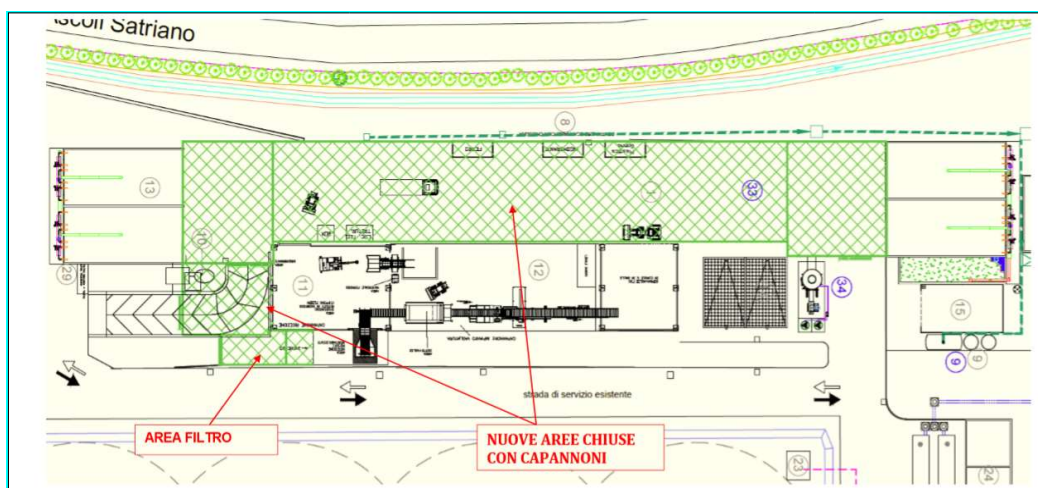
stralcio della TAV.7a Planimetria Generale Stato di Progetto – Linea trattamento RUR
